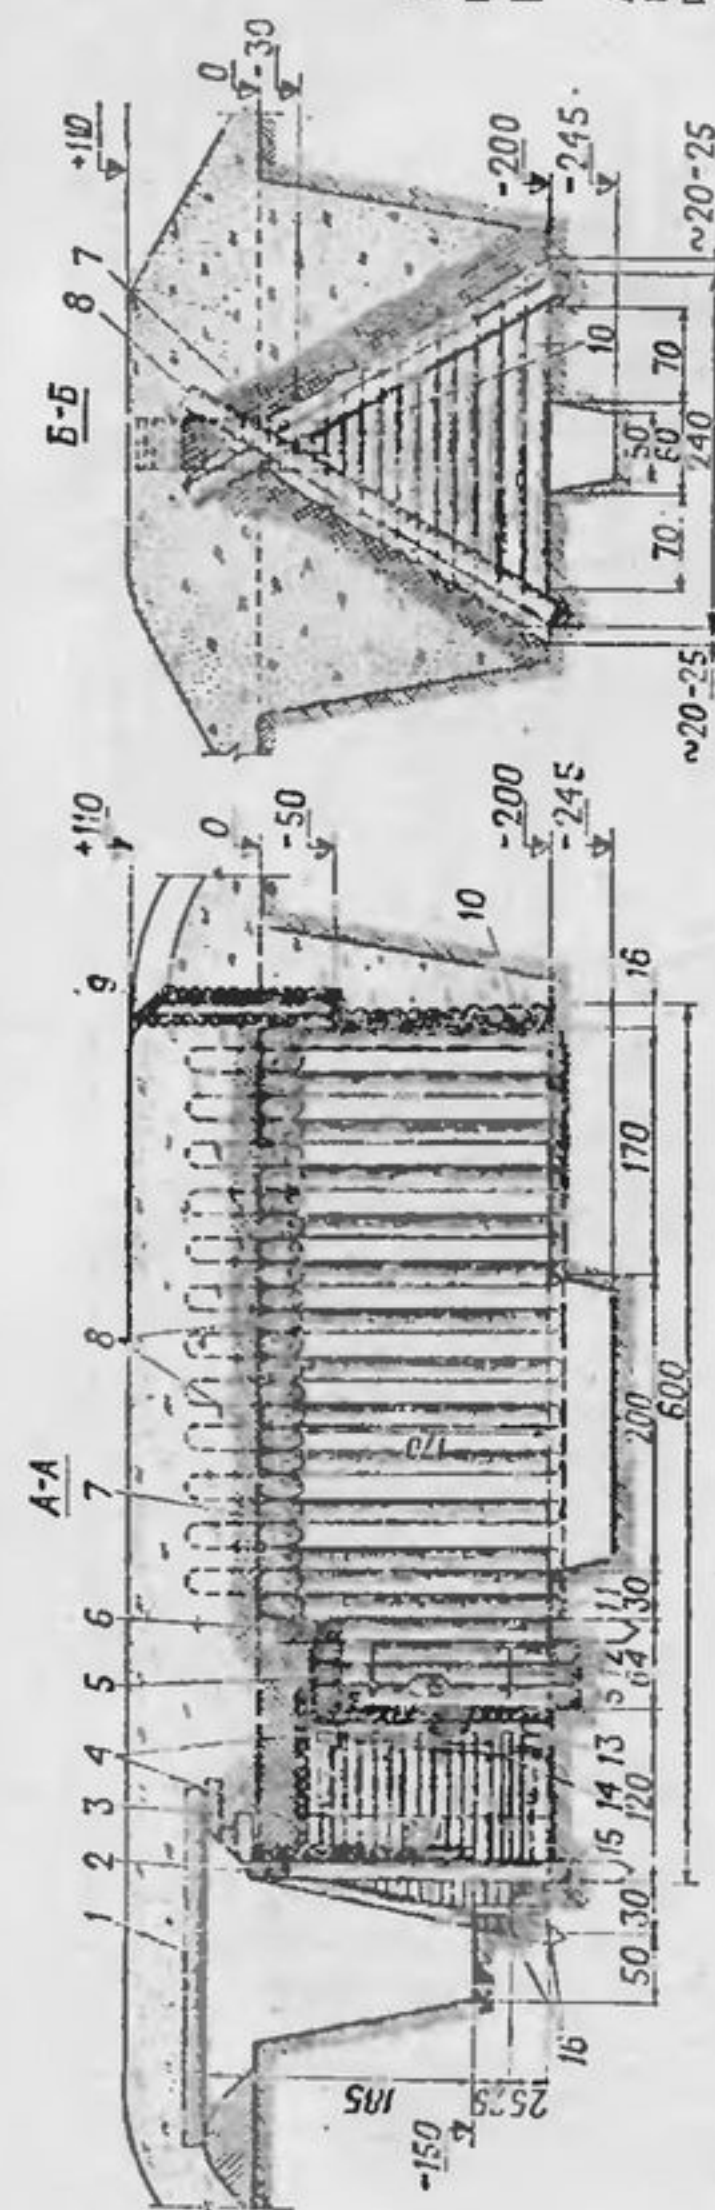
Блиндаж шатровой конструкции из круглого леса:
